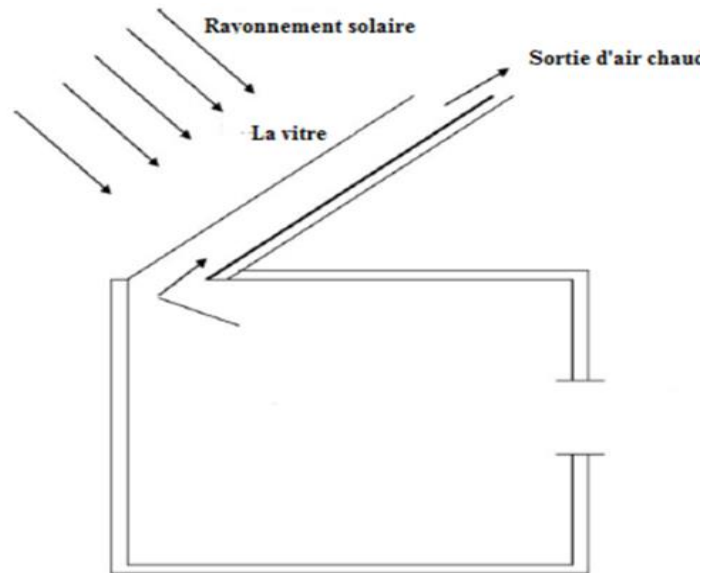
Installation d'une cheminée solaire inclinée [9]
